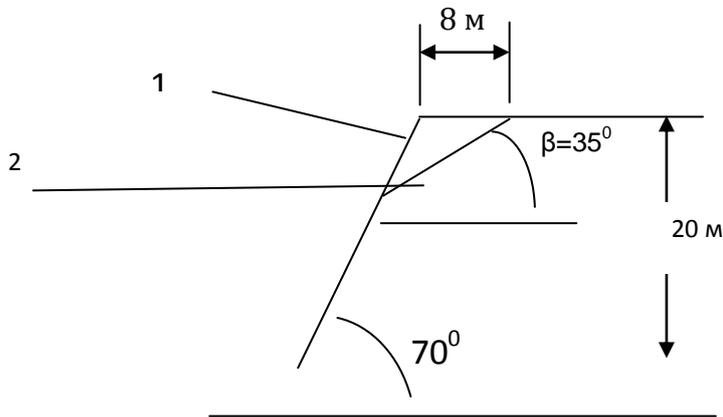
Схема поперечного сечения уступа: 1 - откос; 2 - поверхность ослабления
